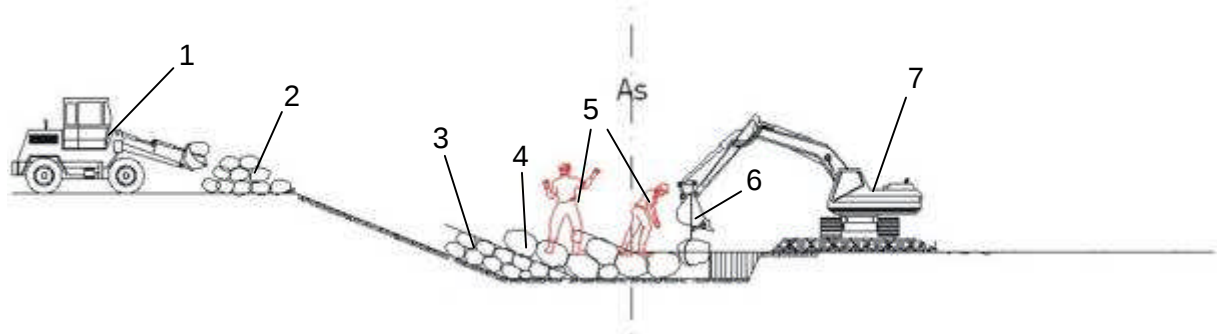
penggalian tanah pondasi (kaki bangunan) saat air surut
